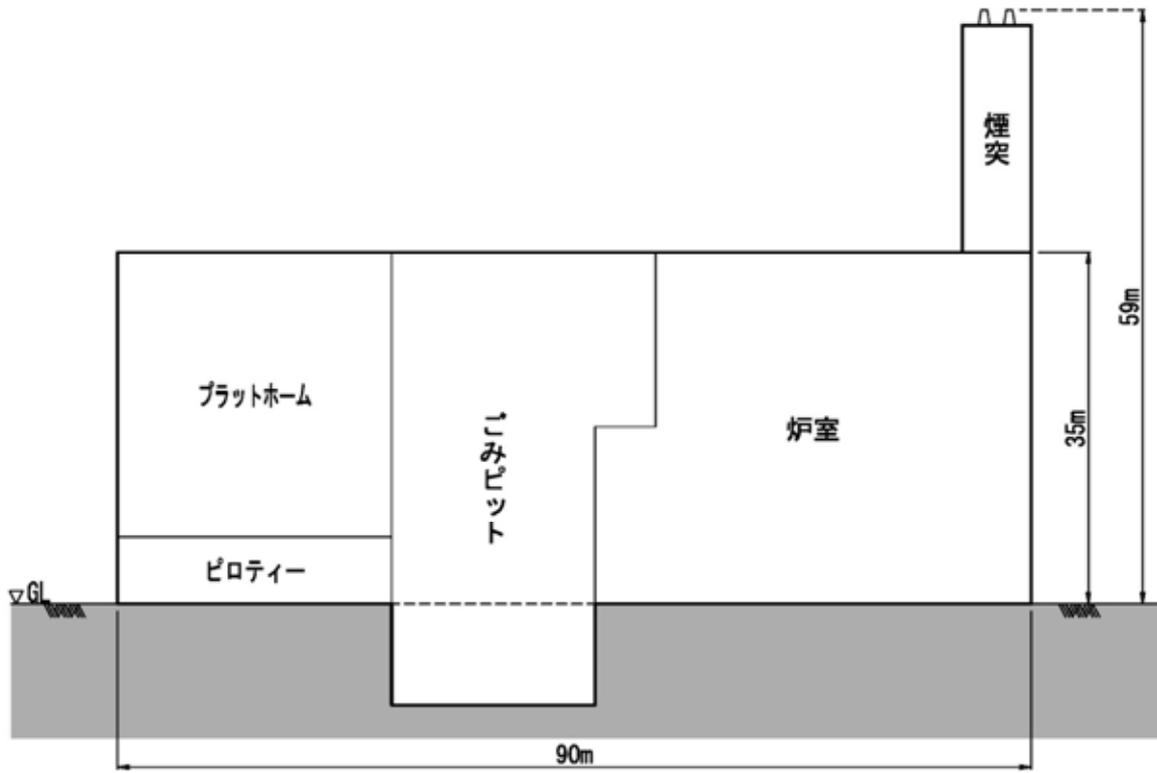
工場棟の主要施設配置概略図（断面図）
